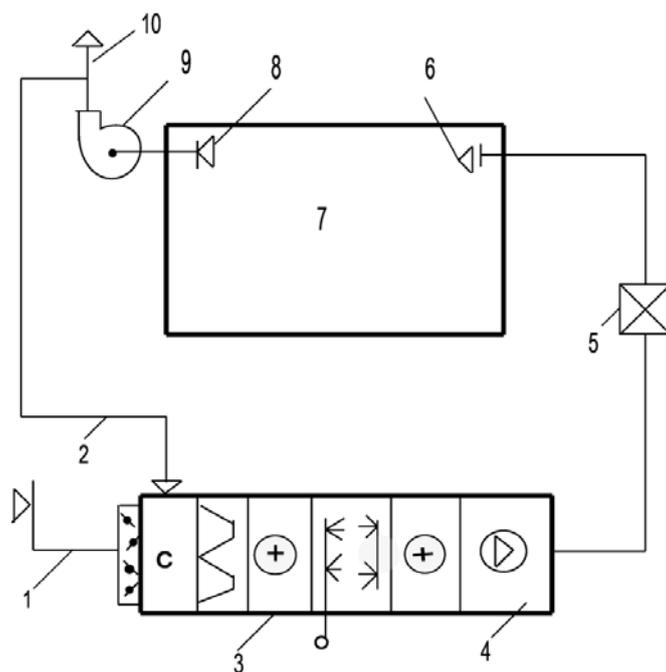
Принципиальная схема системы кондиционирования воздуха: 1 – воздухозаборное устройство; 2 – рециркуляционный воздуховод; 3 – установка кондиционирования воздуха; 4 – приточный вентилятор; 5 – доводчик; 6 – система распределения воздуха; 7 – помещение; 8 – система удаления воздуха; 9 – вытяжной вентилятор; 10 – канал для выброса воздуха
